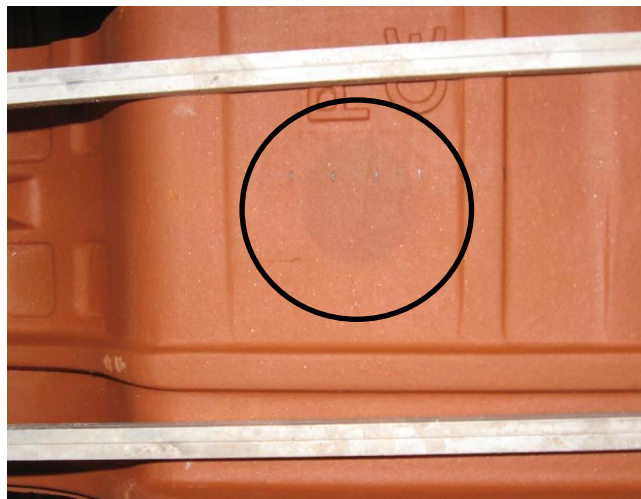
Face oposta à aplicação do cachimbo com mancha de água.
